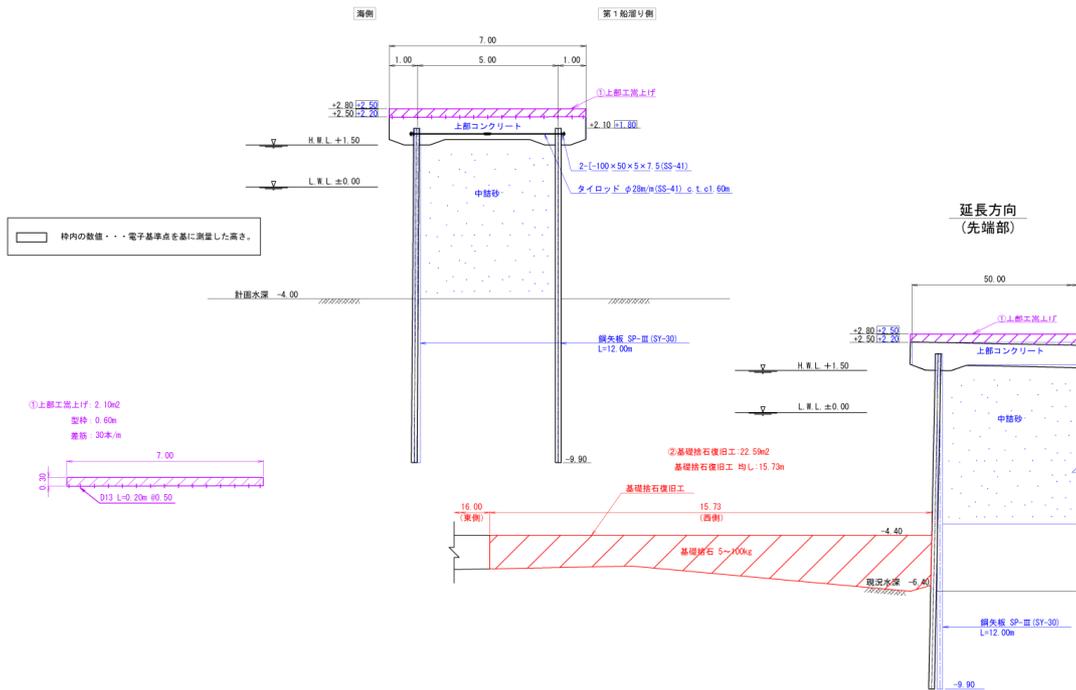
No.14 日立港区_第5埠頭地区第1船だまりの西断面図(復旧後)
